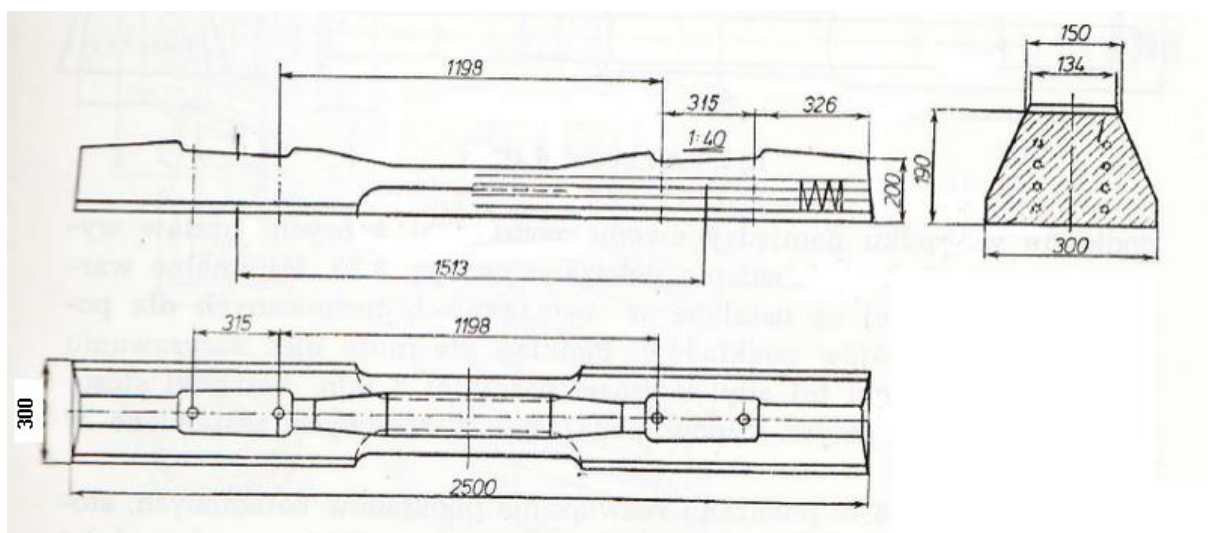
Podkład strunobetonowy PS-83/K (zmodernizowany INBK-7) z przytwierdzeniem klasycznym typu K.
